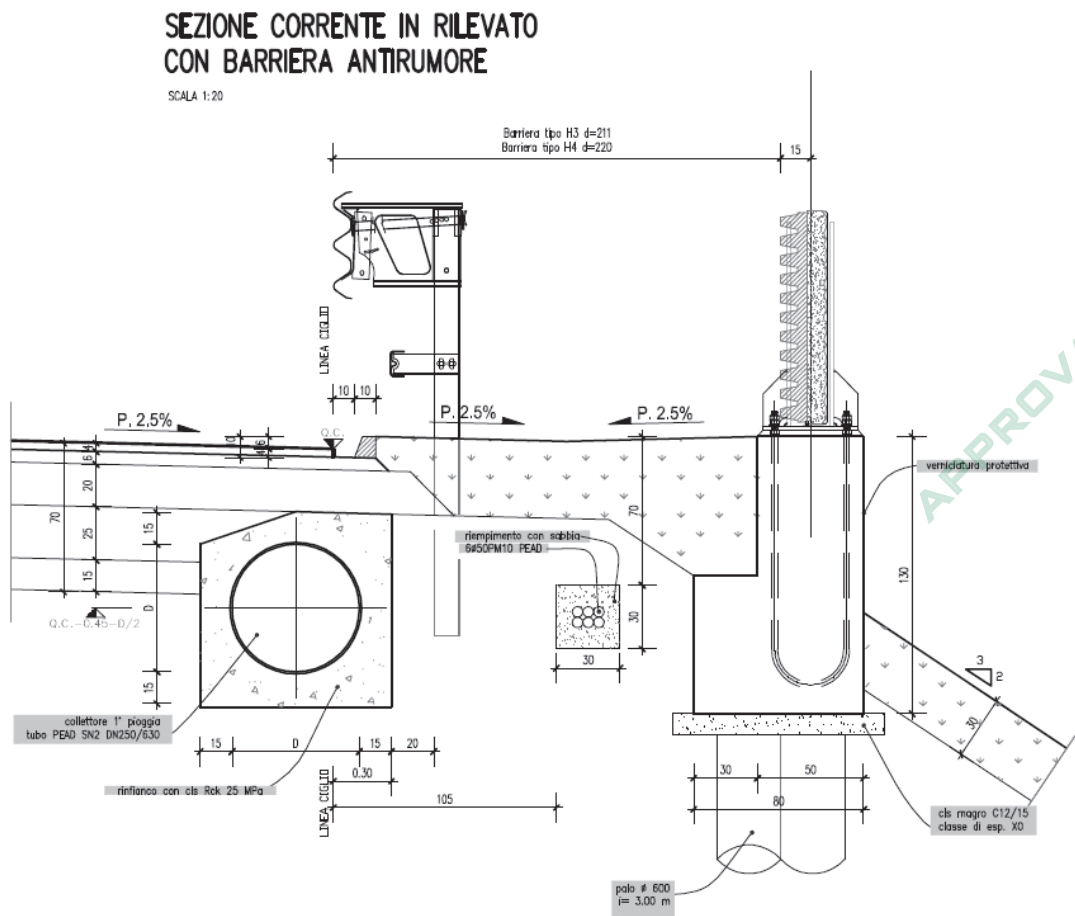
Schema fondazione barriere fonoassorbenti
